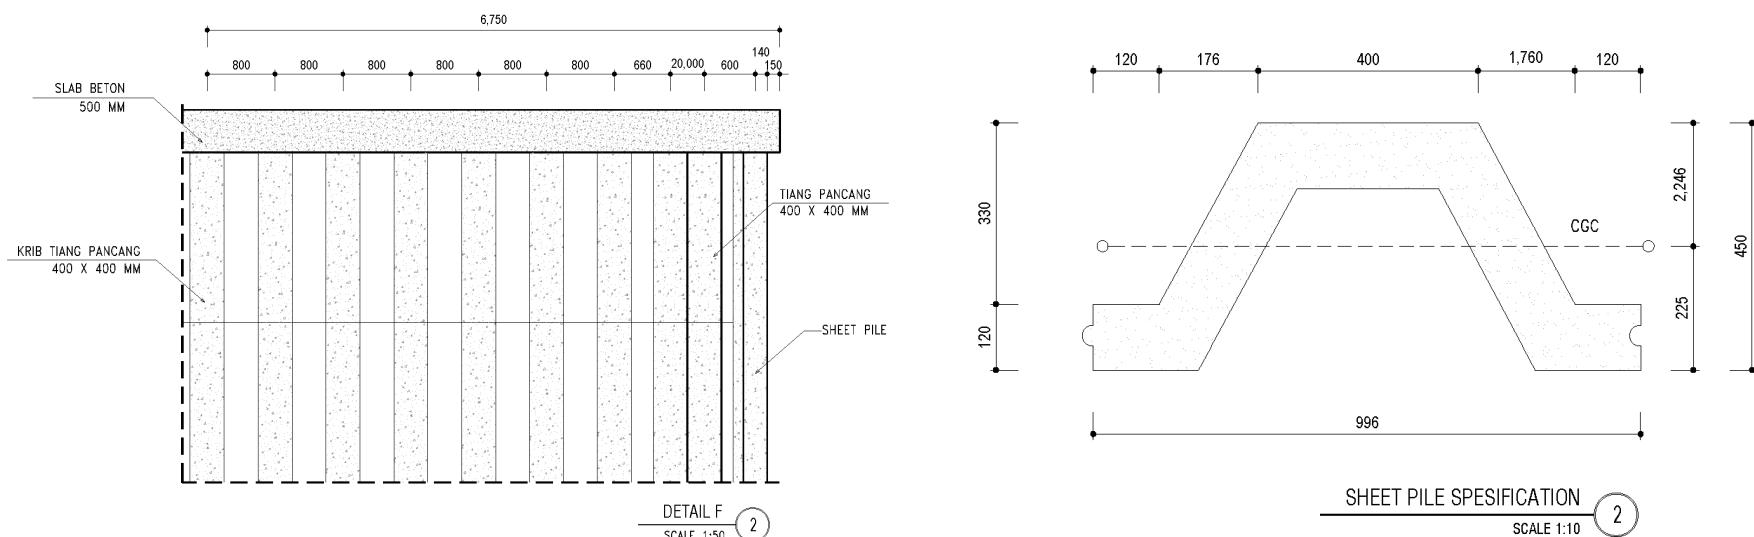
Layout Parsial Alternatif 2 Sheetpile
